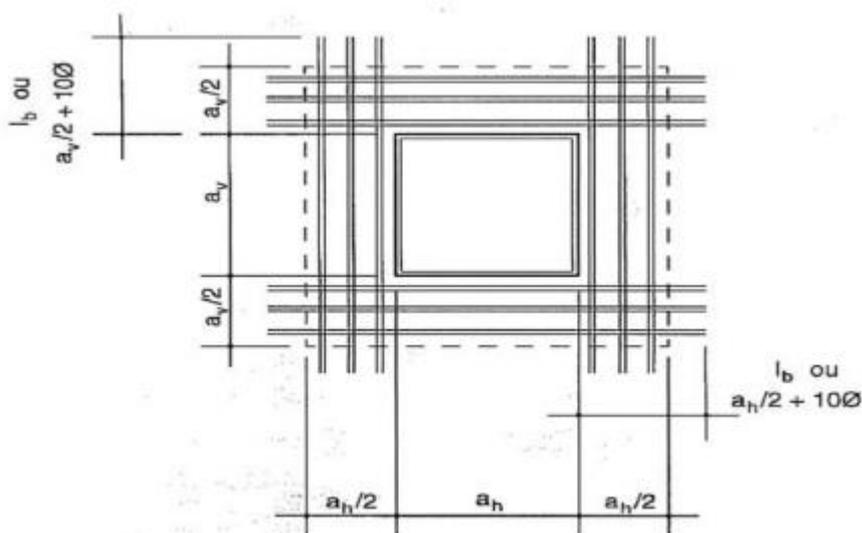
Esquema das armaduras de reforço (Fonte NBR 16055 (2012))
